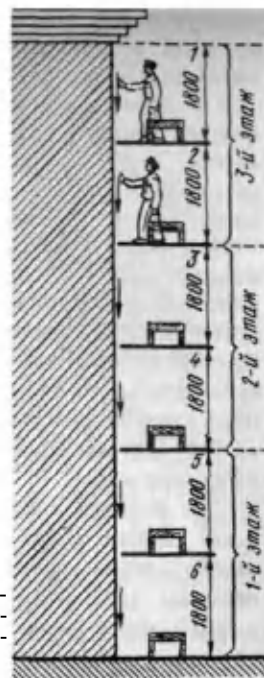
Оштукатуривание фасада вертикально расположенными захватами
